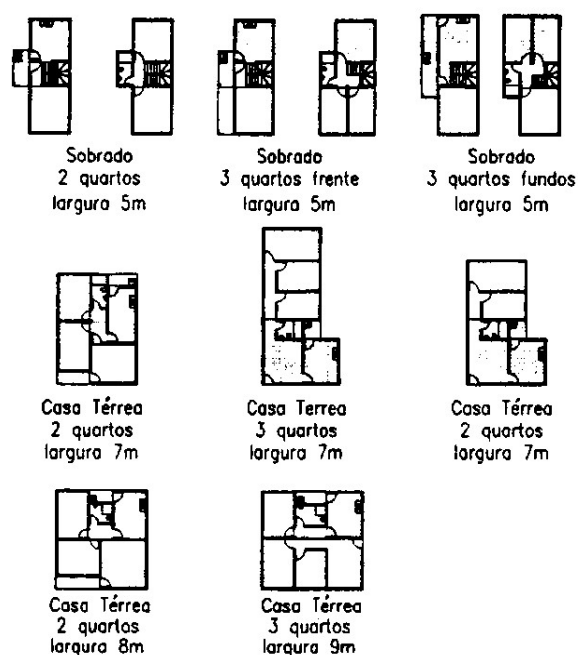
Layouts básicos detalhando a primeira etapa da construção em projeto de habitações de interesse social, Campinas, São Paulo (Fonte: KOWALTOWSKI et al., 1995)
